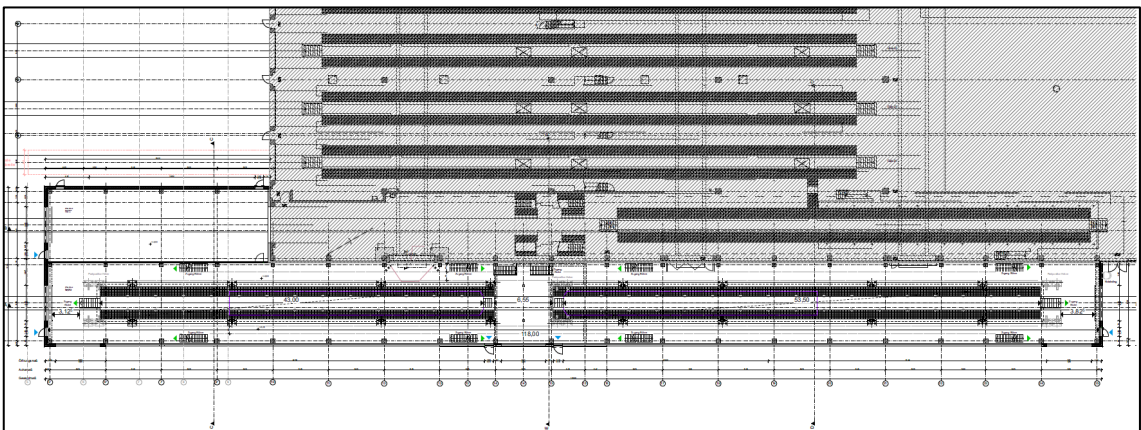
Grundriss Erdgeschoss [2.a]
